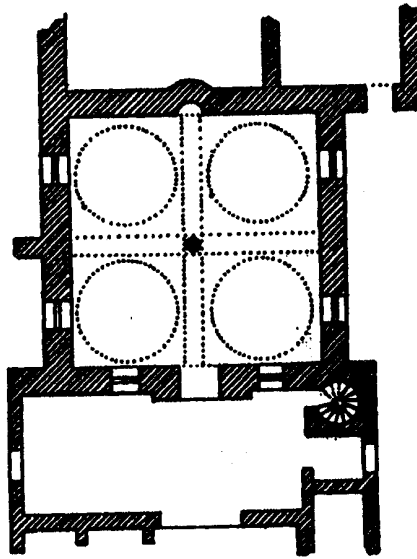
مسقط أفقي لجامع قمرية بغداد
